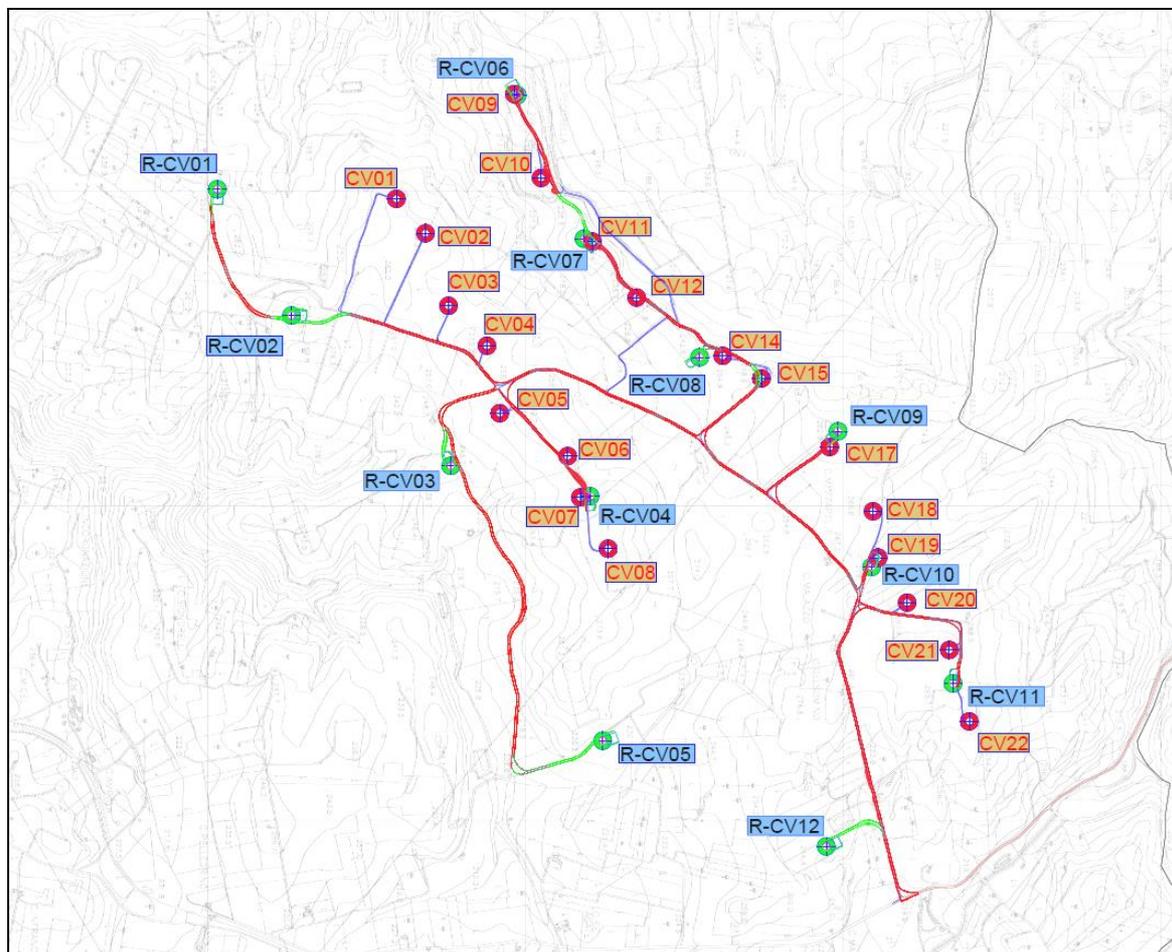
Sovrapposizione del layout impianto esistente con layout impianto potenziato Castelvetrano (in verde le nuove viabilità)
